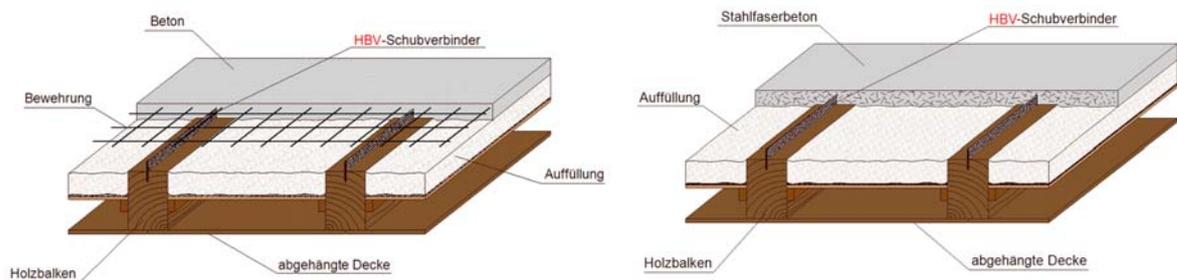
Sanierung von Holzbalkendecken mit eingebrachter und schubfest verbundener Betonschicht
